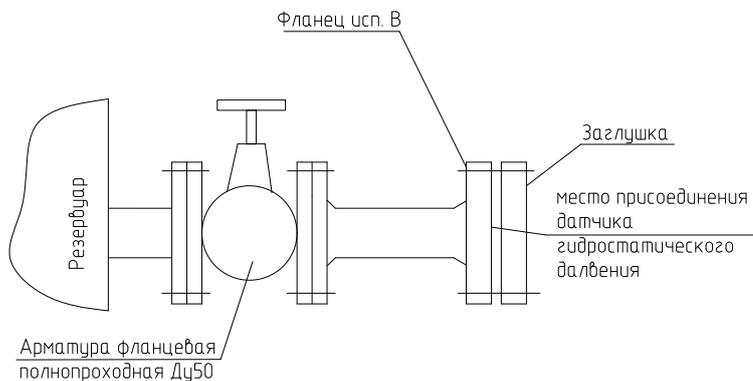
Эскиз патрубка для датчика гидростатического давления, штуцер выполнить вдоль стенки резервуара
